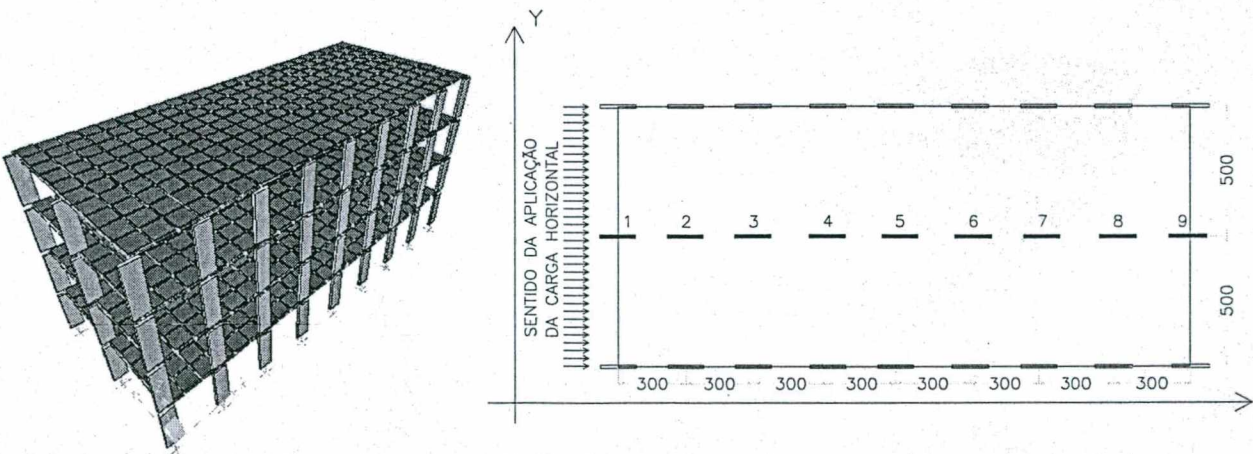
Perspectiva e planta baixa do edifício 10x24m com 4 pavimentos
